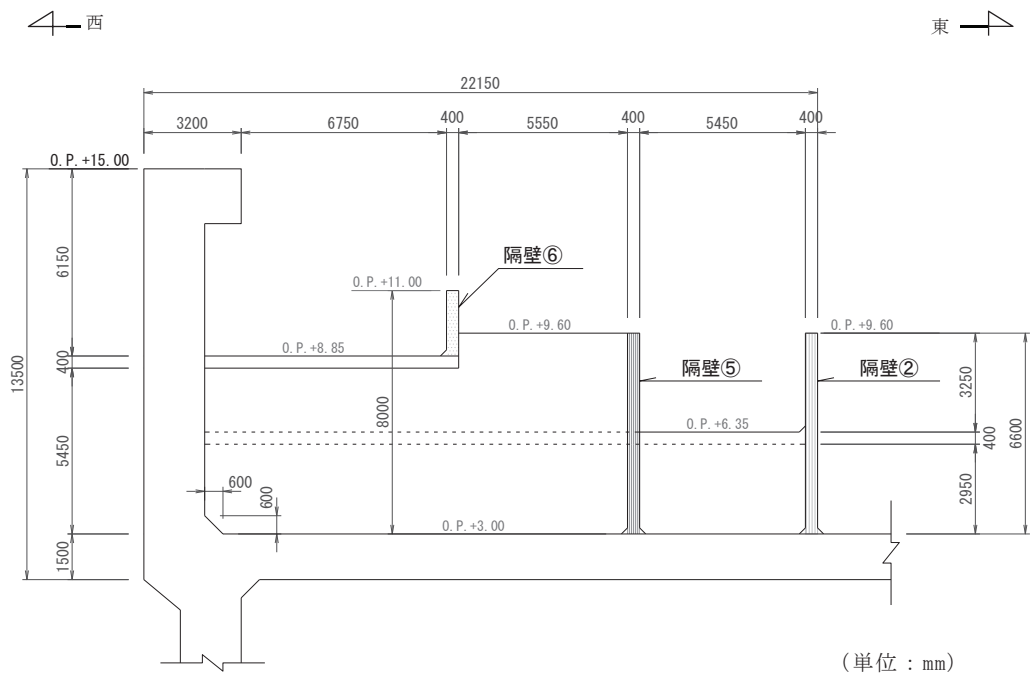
(6) 補機ポンプエリア断面図 (⑥—⑥断面)
